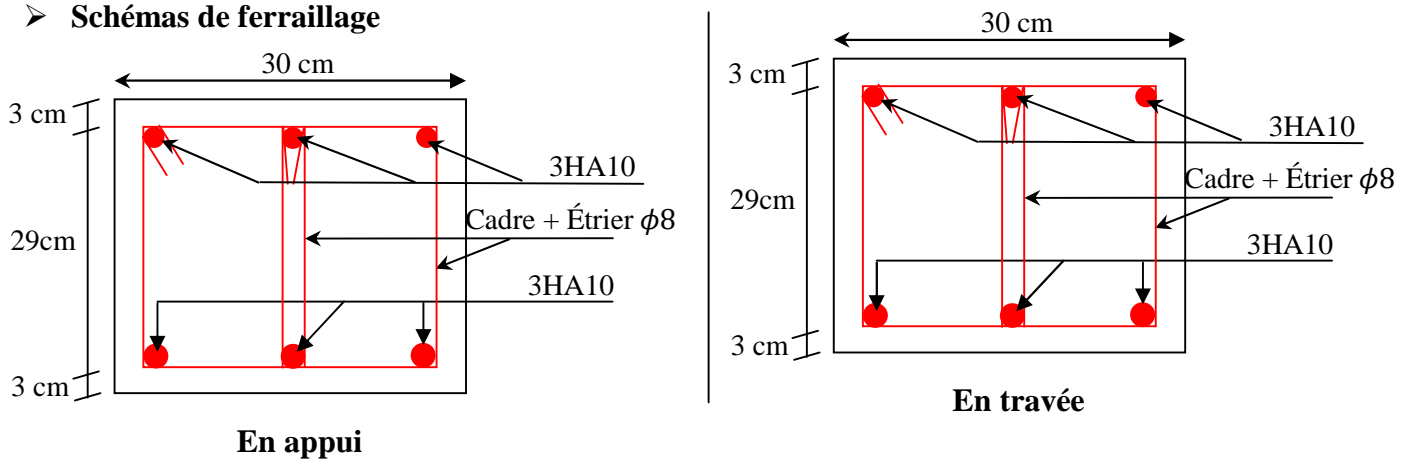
Schéma de ferrailage de la poutre de chaînage
